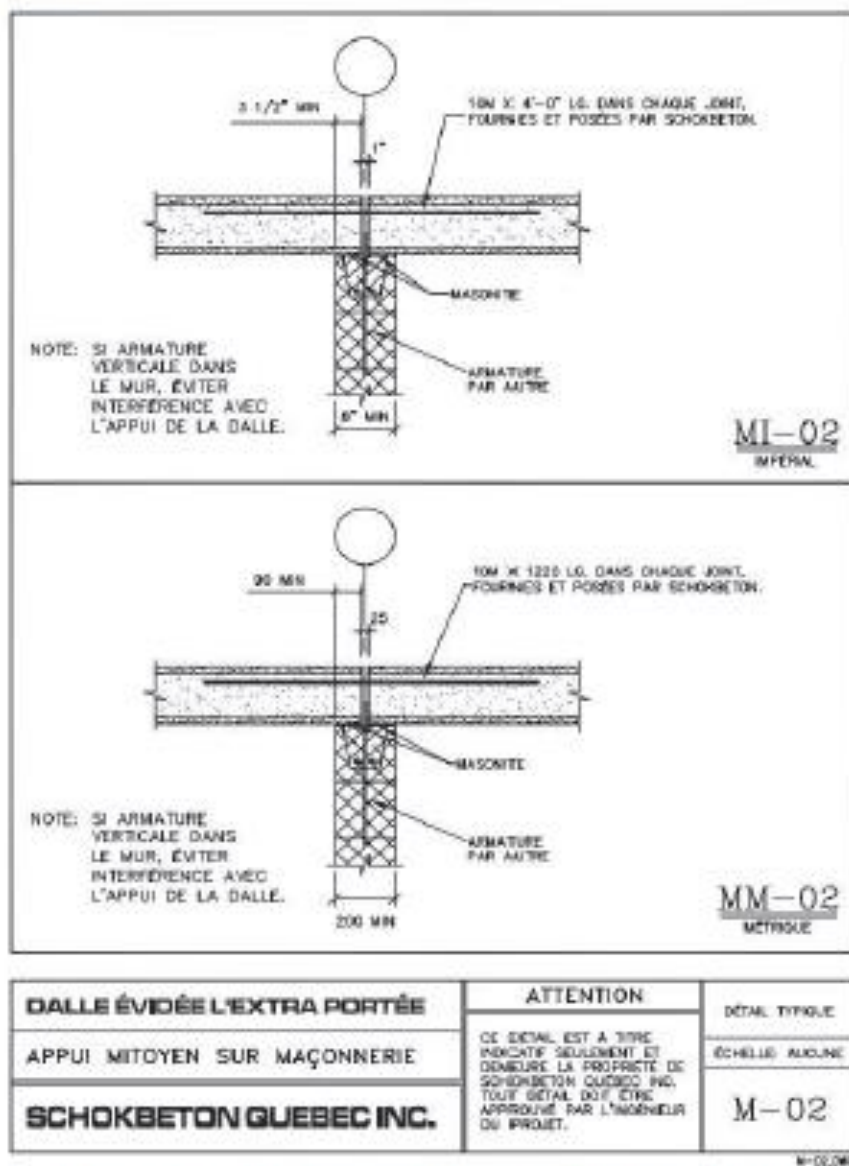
Dessin technique d'un appui mitoyen sur maçonnerie pour deux dalles précontraintes alvéolées (image tirée du site SARASCHOK.COM)
